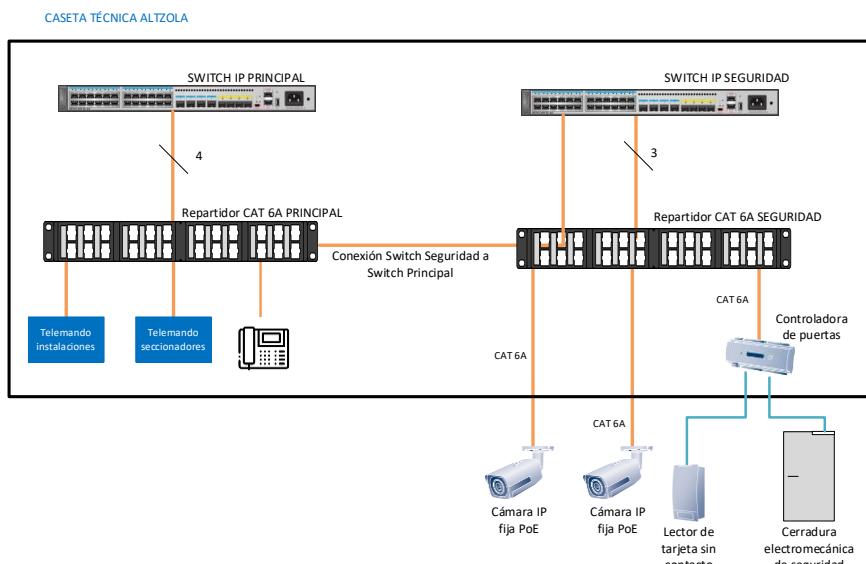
Arquitectura prevista red LAN y cableado estructurado caseta técnica Altzola
